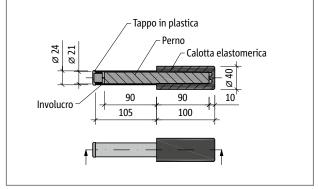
Schöck Tronsole® tipo D-H: pianta del prodotto
